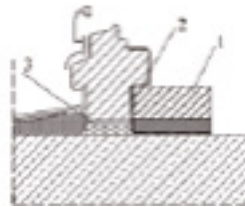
Sposób zamocowania parapetu zewnętrznego do okna drewnianego
